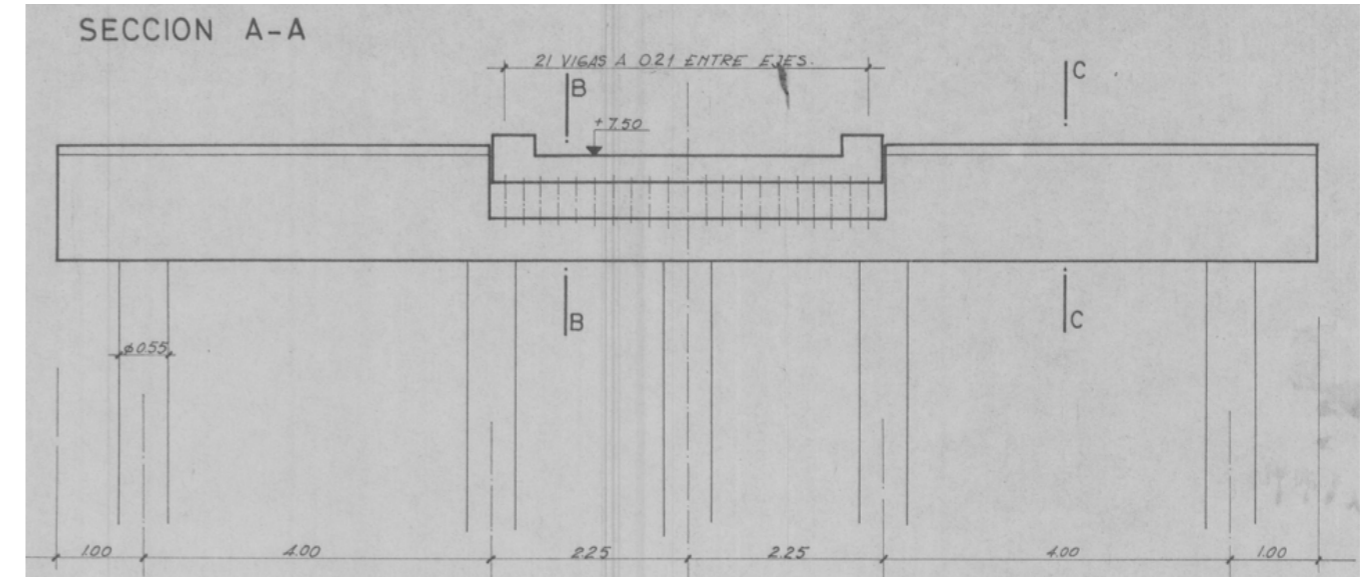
Sección transversal del tablero del tramo 1 - incluye dintel
